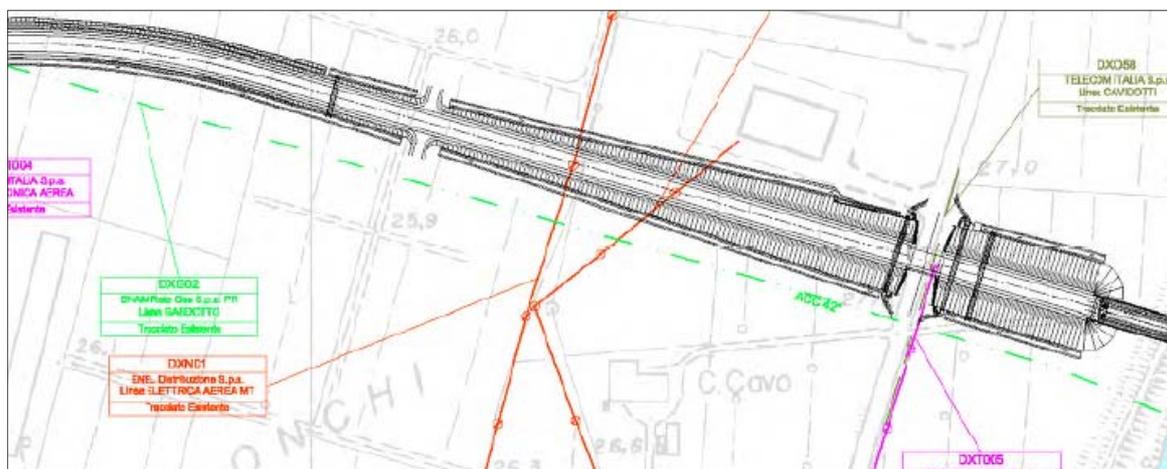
STRALCIO PLANIMETRICO, IN VERDE IL GASDOTTO SNAM
